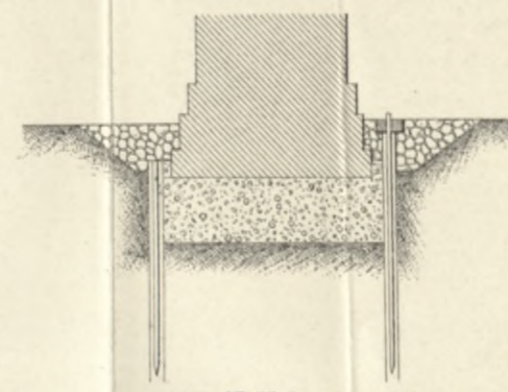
Hölzerner Mantel f.d. Pfeiler der Brücke über die Creuze. M. 1:200.
